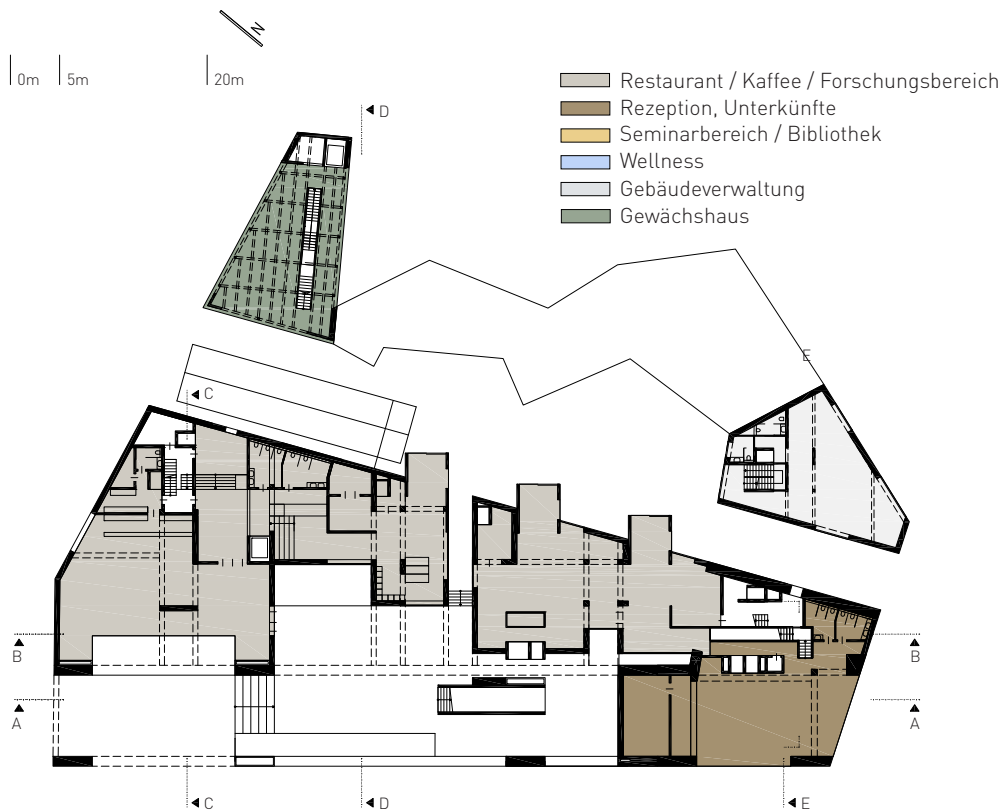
Grundriss Funktionen EG +0,00m / Platz +1,00m
